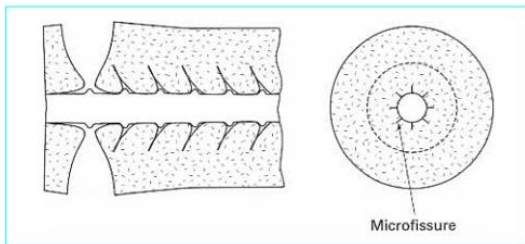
Déformation du béton autour de l'acier, après formation de fissures internes. Source : Marc MAMILLAN, Restauration des bâtiments en béton armé techniques de l'Ingénieur. traité Construction. P4
